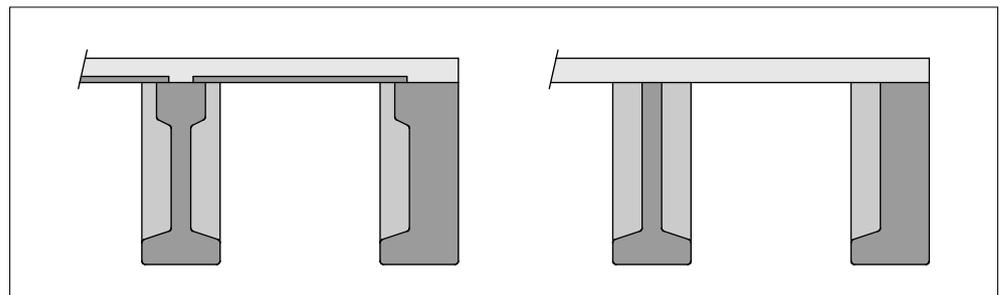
Poutre de rive: poutre en I et en T renversé adaptée
